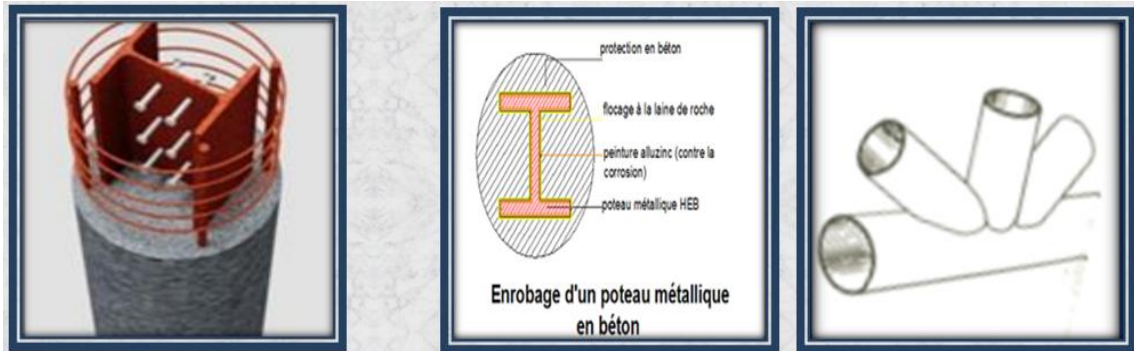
Poteau en structure mixte      Figure 129 : système tridimensionnelles utilisé dans Notre Projet.
